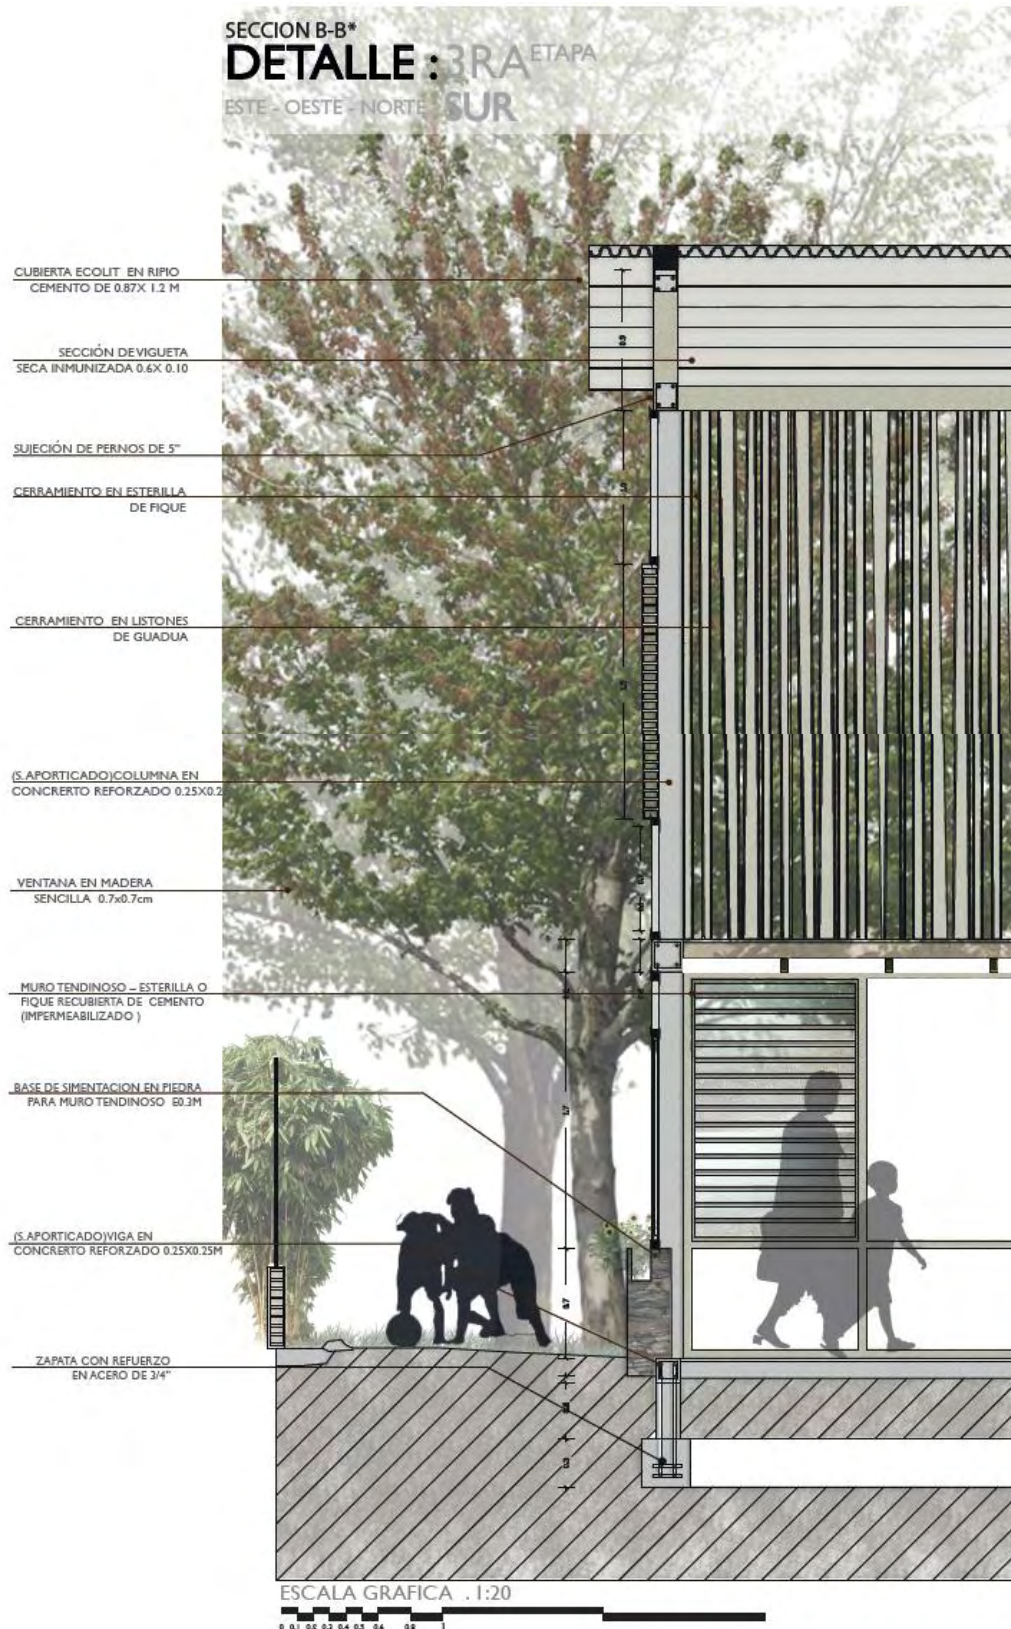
Detalle 3ra etapa Sur vivienda A1 Fuente: propia
